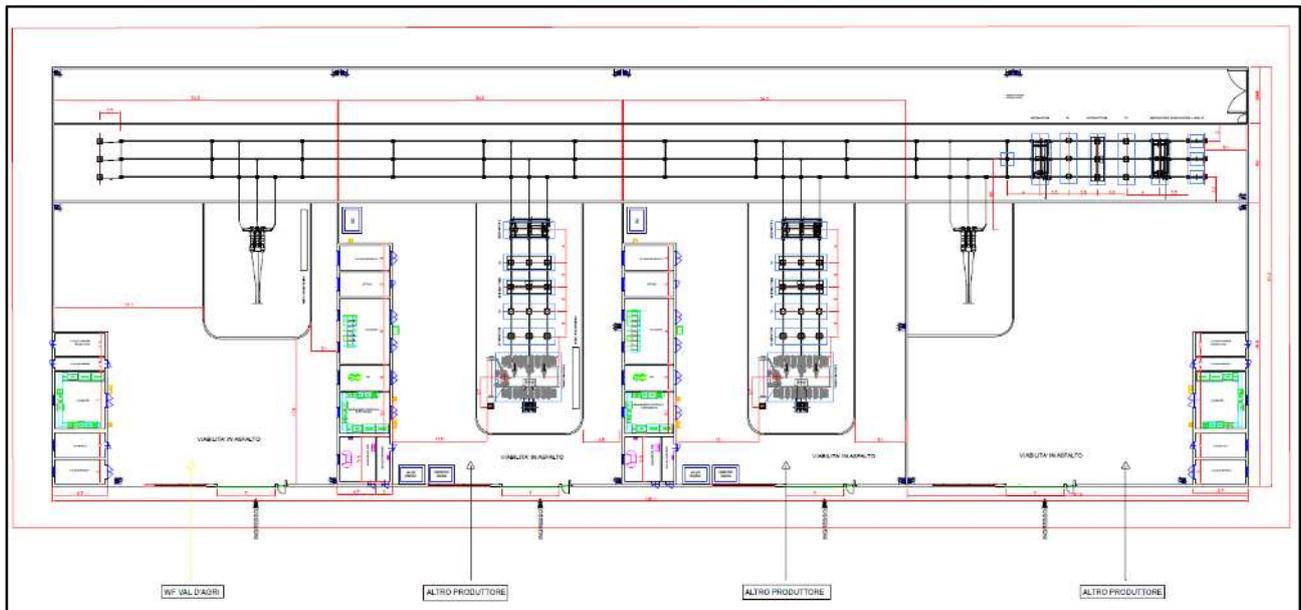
Planimetria elettromeccanica della sottostazione elettrica condivisa
